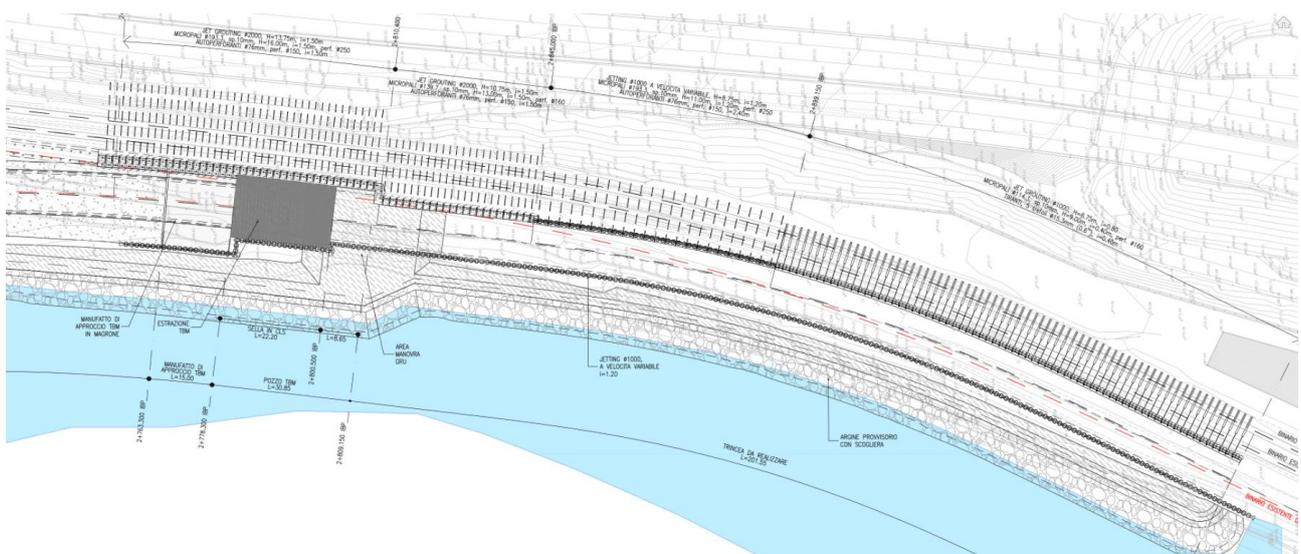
Inquadramento planimetrico della WBS GA08 – parte 2 : camerone di estrazione e trincea
